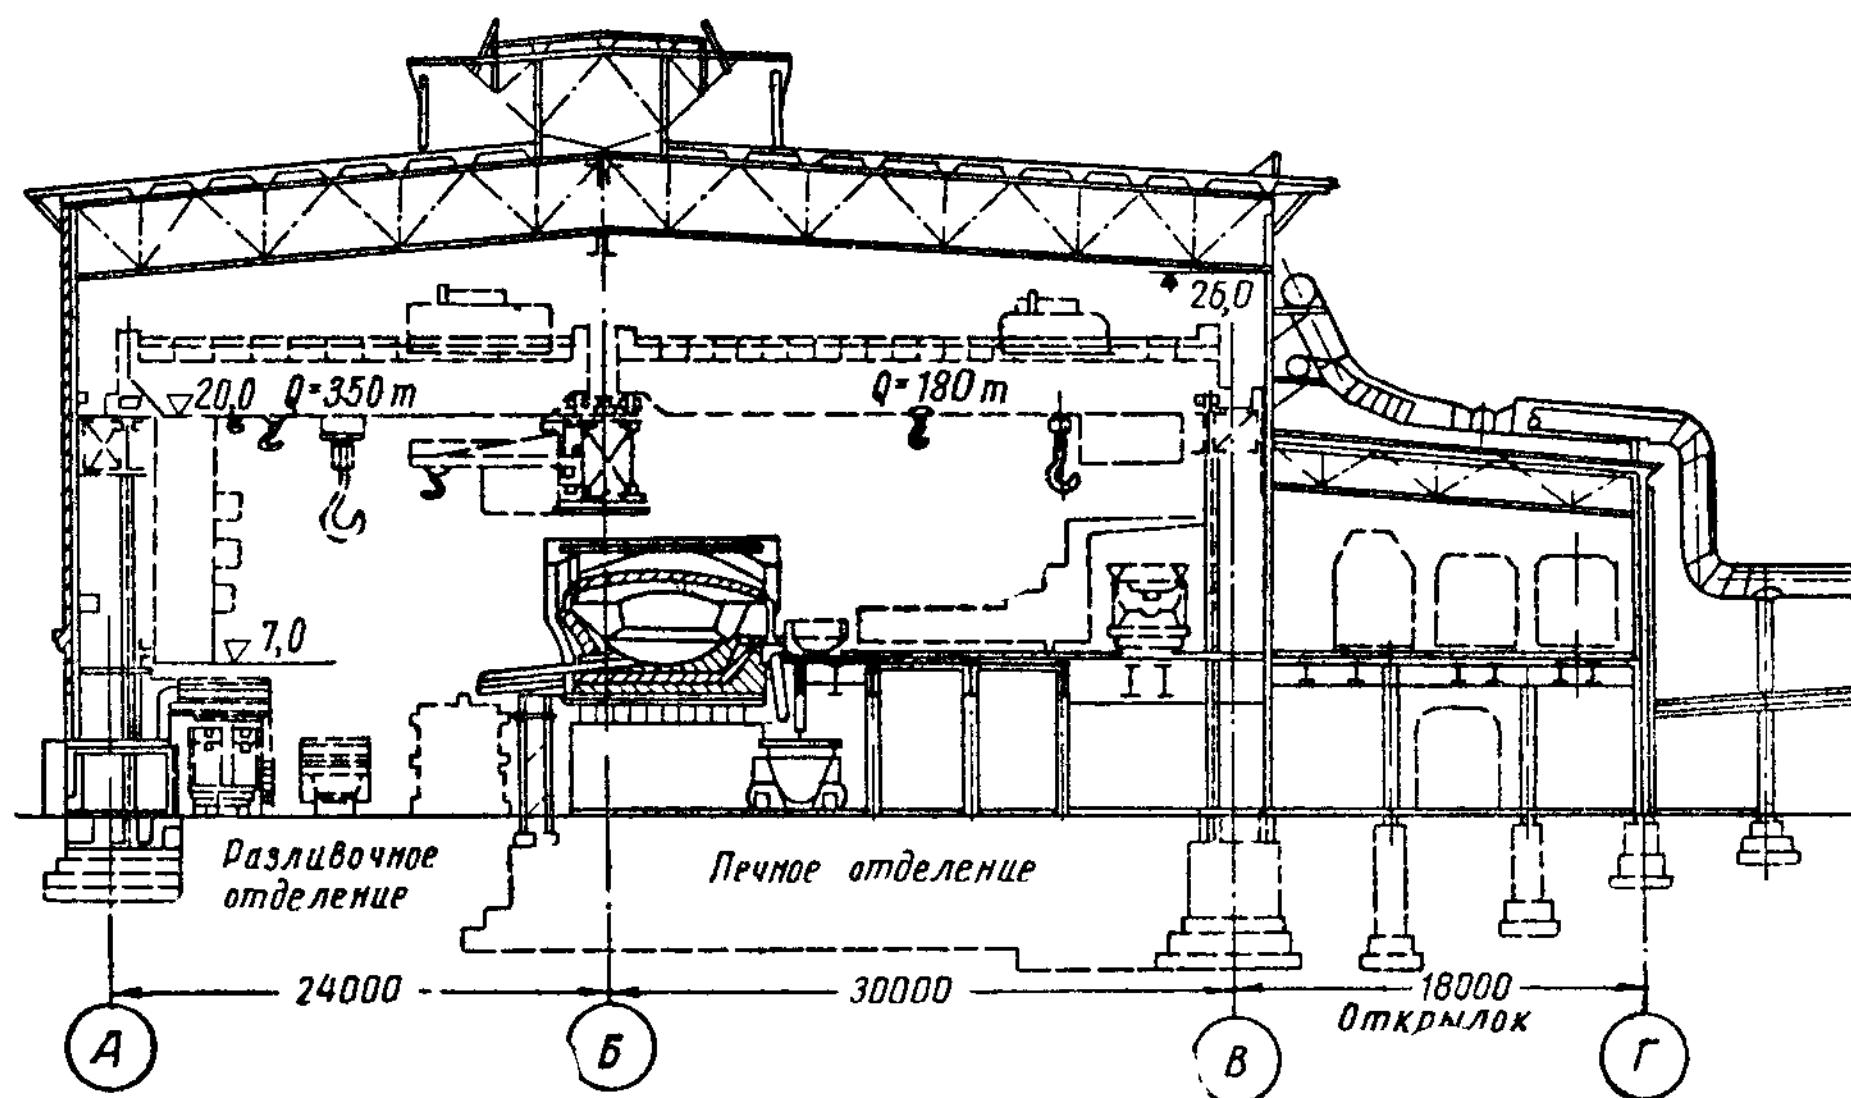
Поперечный разрез конструкций здания мартеновских печей (между основными рамами)
